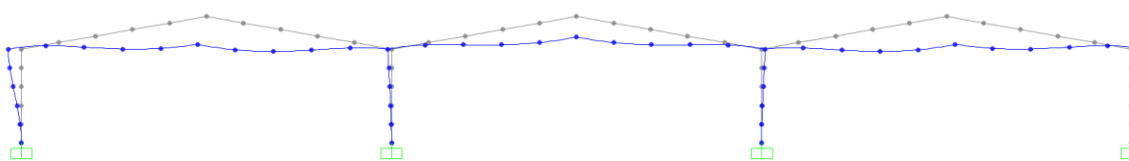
Configuração deformada devido ao carregamento vertical – W (Pórtico PE3)
